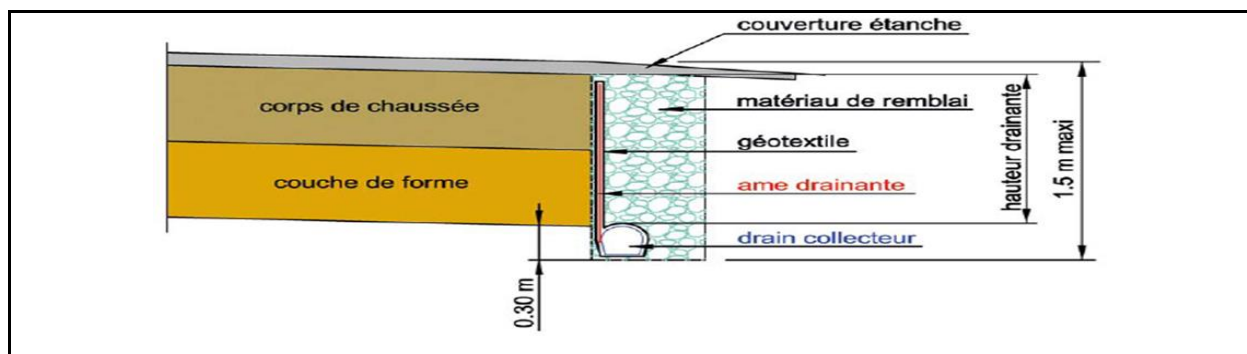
Schéma d'un EDRC situé en limite d'accotement de la structure de chaussée
